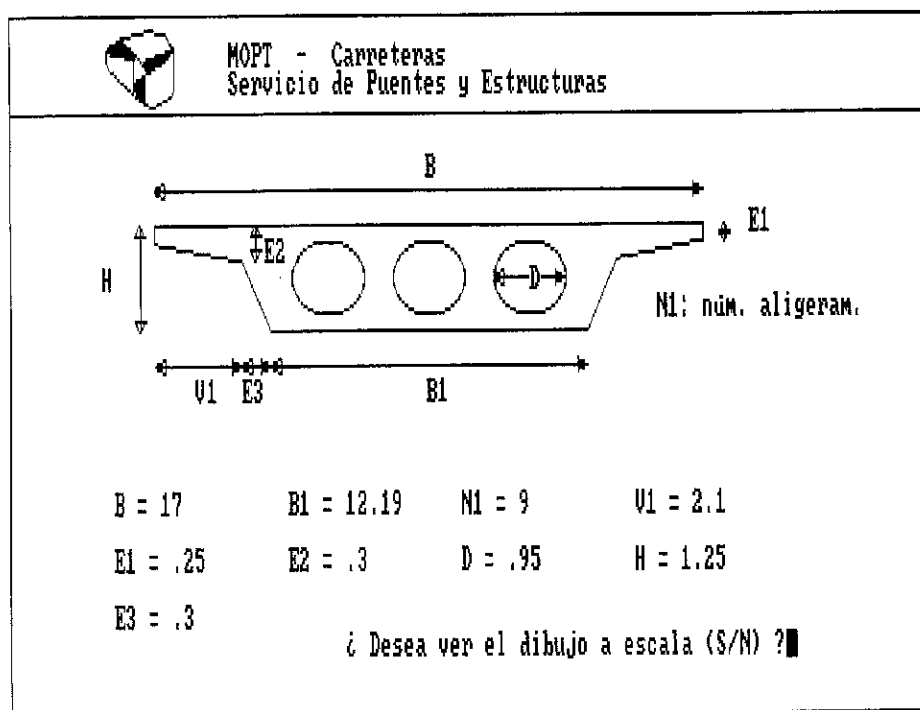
Puente de 3 vanos y 17 m de anchura, de luces 20 + 30 + 20 m. Sección transversal propuesta (Tipo 1).
